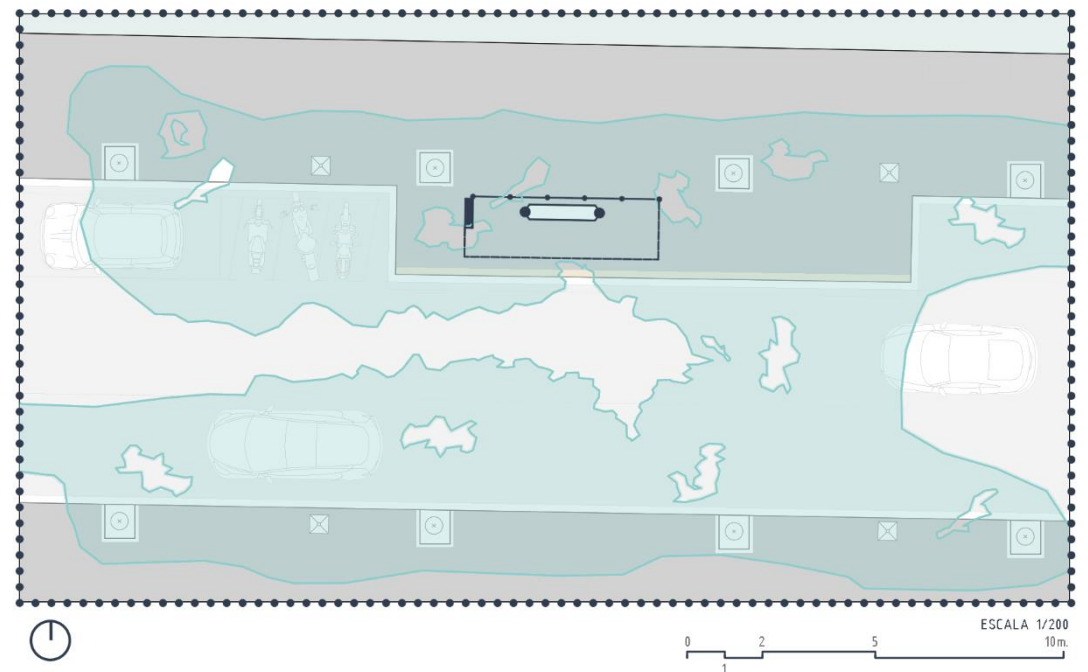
Plano detalle de elaboración propia de la parada de autobús. E 1/200m
